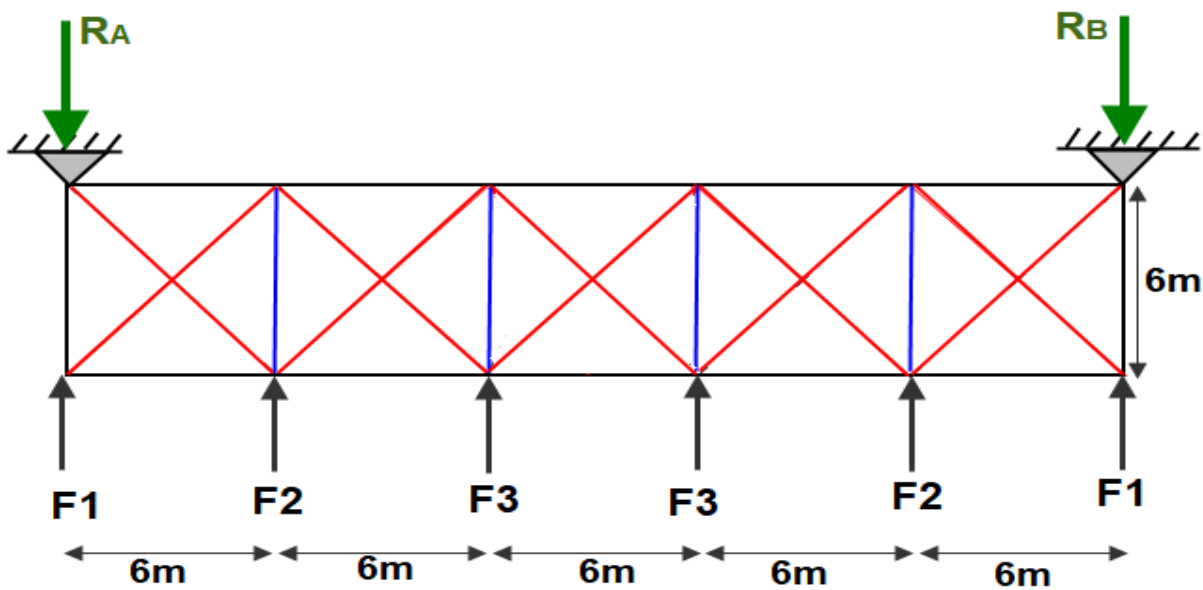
Représentation des forces appliquées à la poutre au vent.
